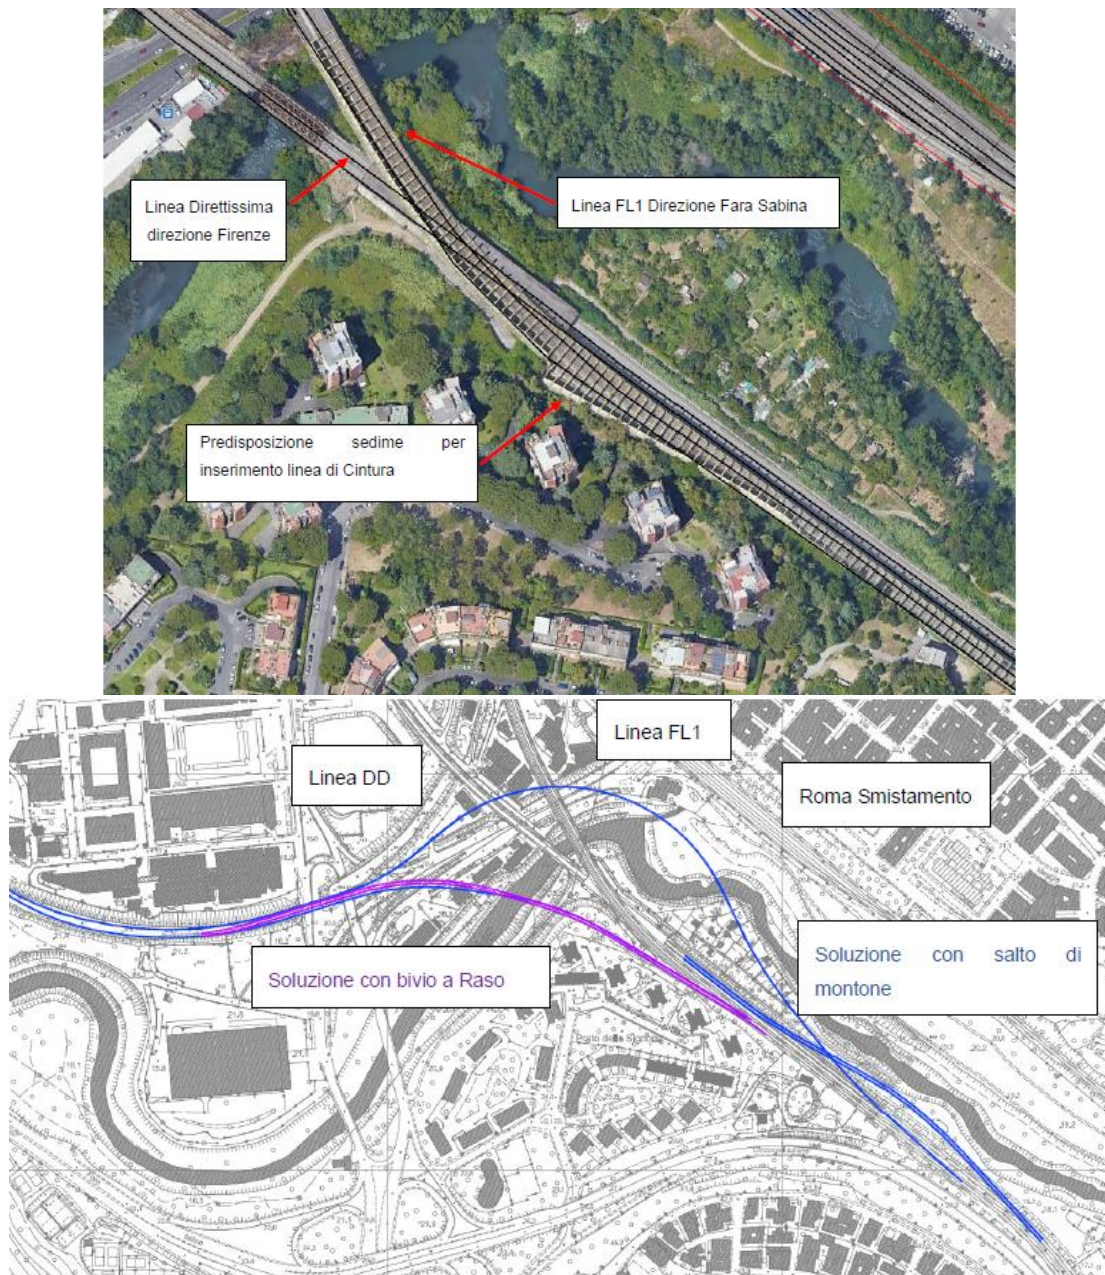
Inquadramento planimetrico alternative di chiusura dell’Anello in corrispondenza della predisposizione esistente.
